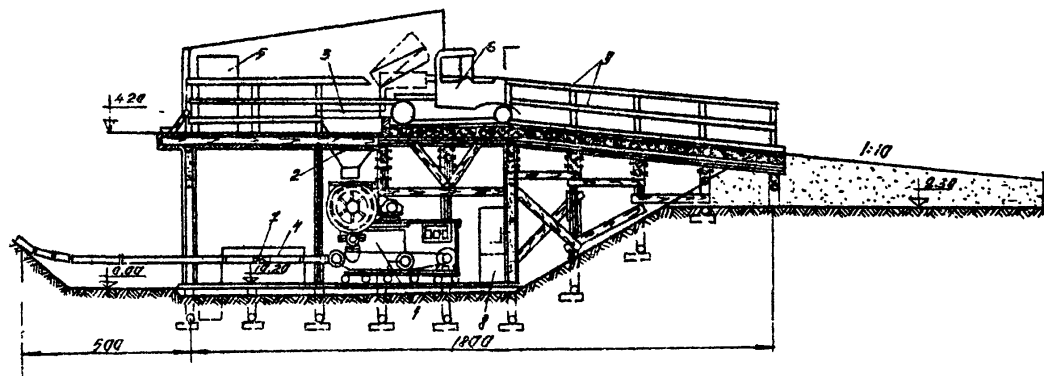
Схема раскладки бетоновода у бетононасоса.
